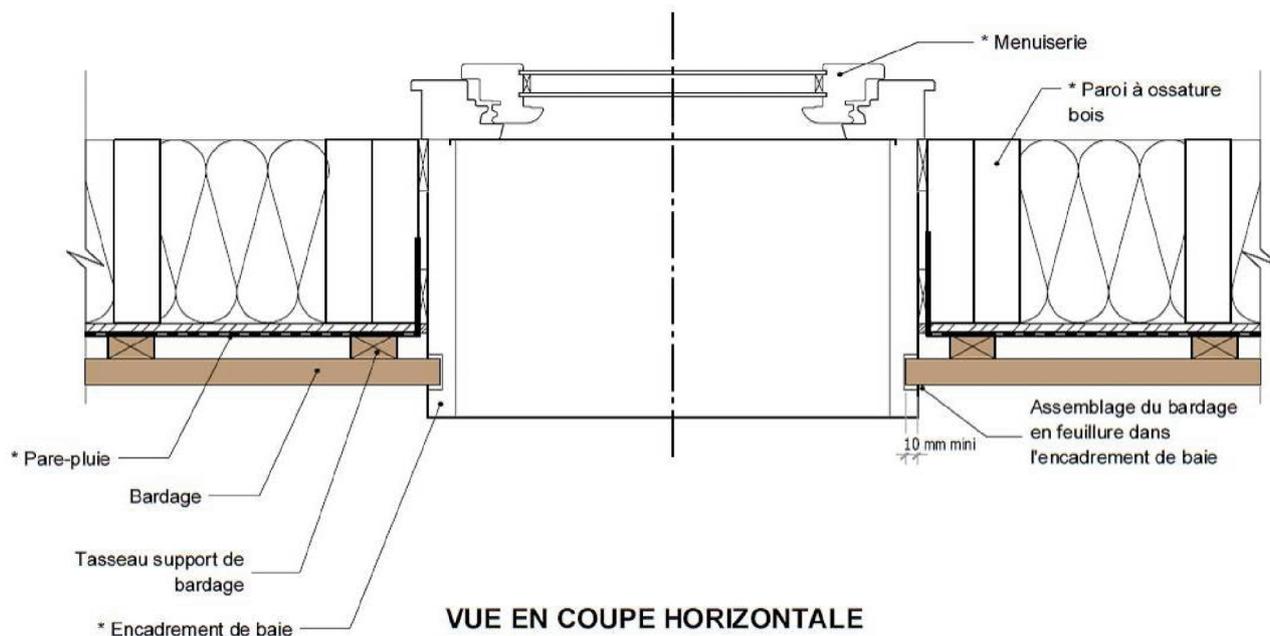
Protection du calfeutrement par l'assemblage bardage / encadrement – coupe horizontale
